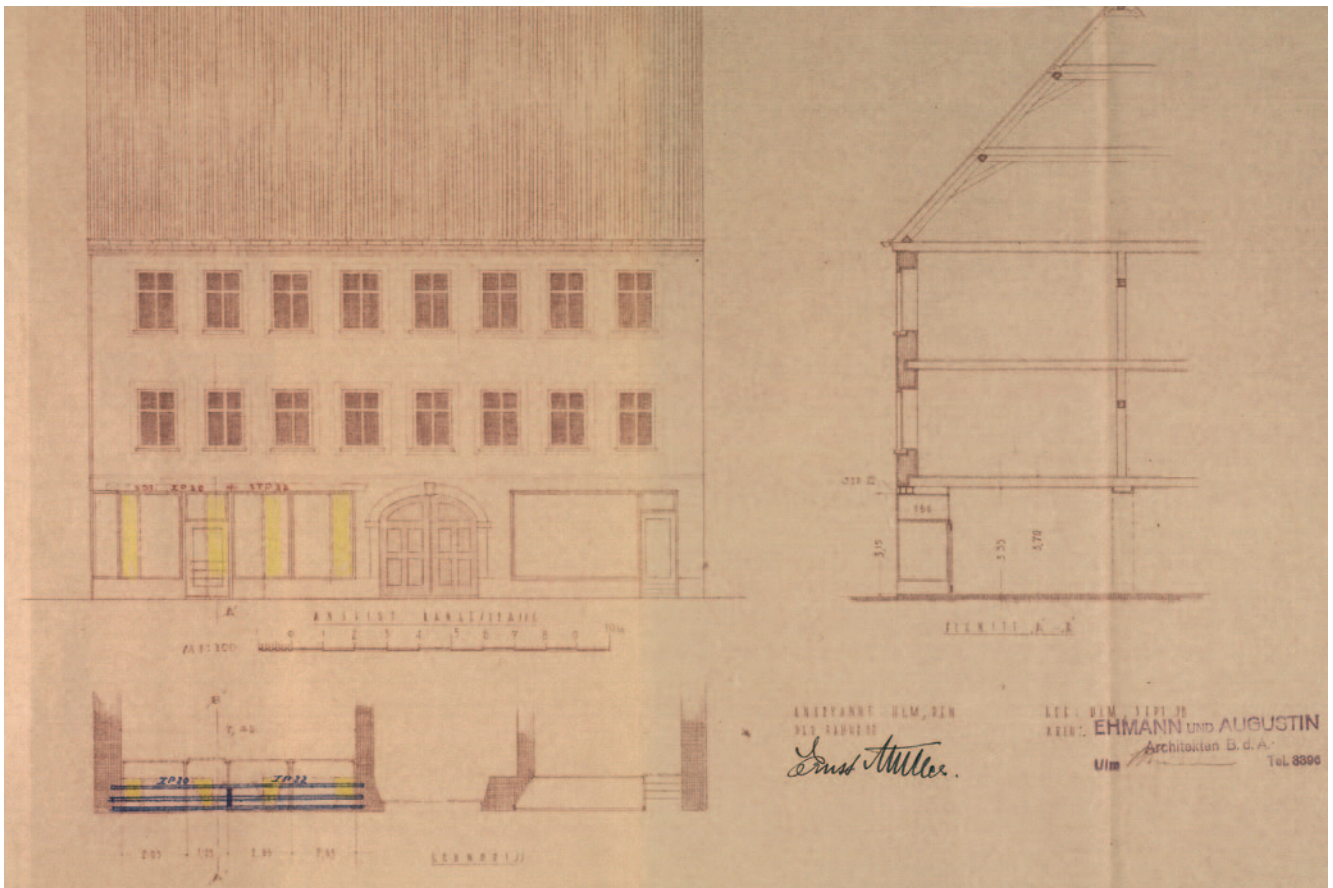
Gebäude Lange Straße 18 (A 262), Ansicht des Vorderhauses mit Querschnittsskizze, Baugesuch zum Ladenausbau 1938.
